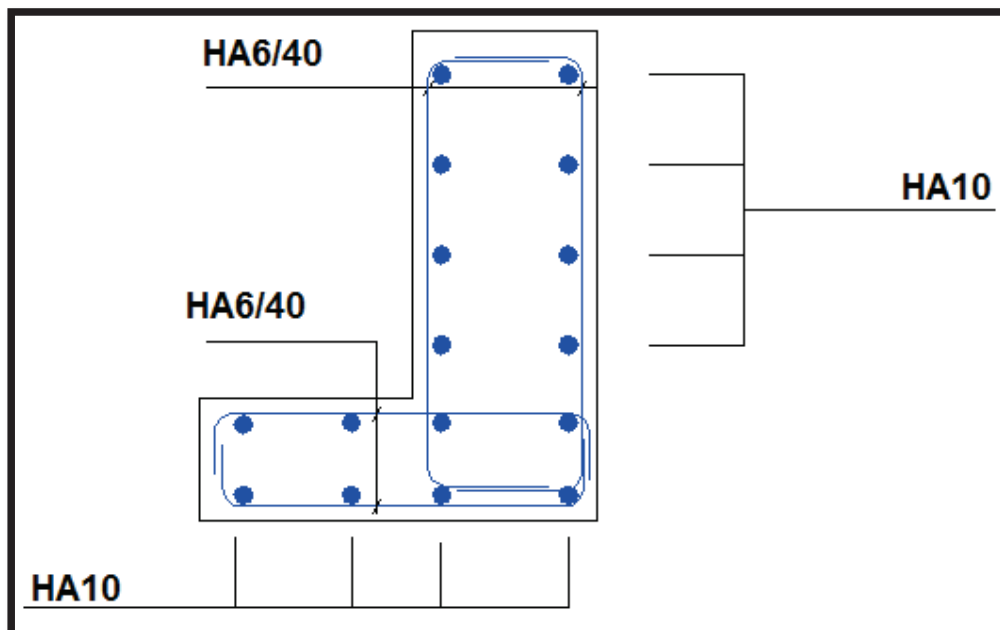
Ferrailage de ma poutre (garde-corps)
